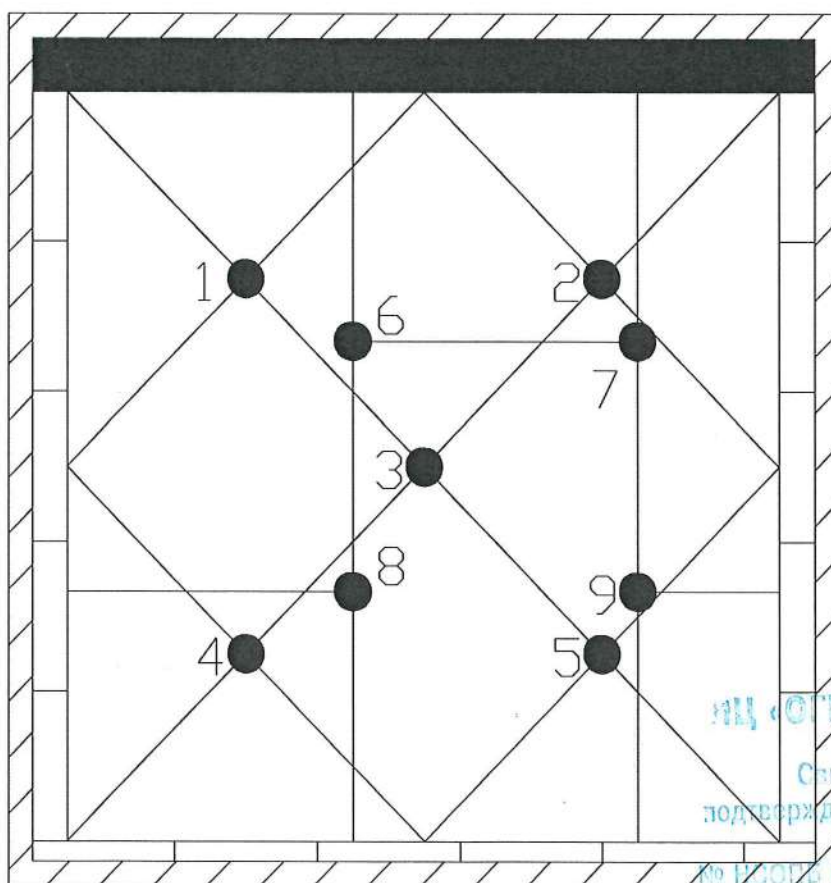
Схема расстановки термопар на необогреваемой поверхности образца №2.
